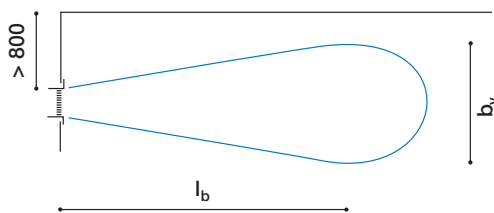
, Portée des grilles installées à plus de 800 mm du plafond.
